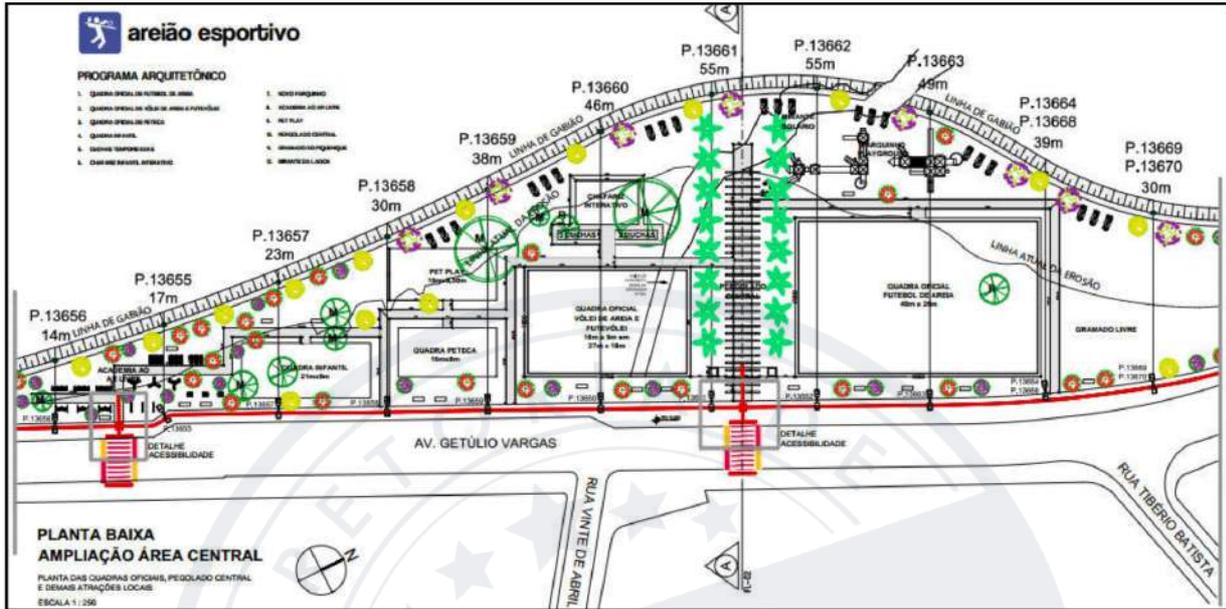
Demonstração da planta baixa do projeto da Praça de Esportes do Areião. Fonte: Processo 2579-23-LST-CDL (adaptado).
